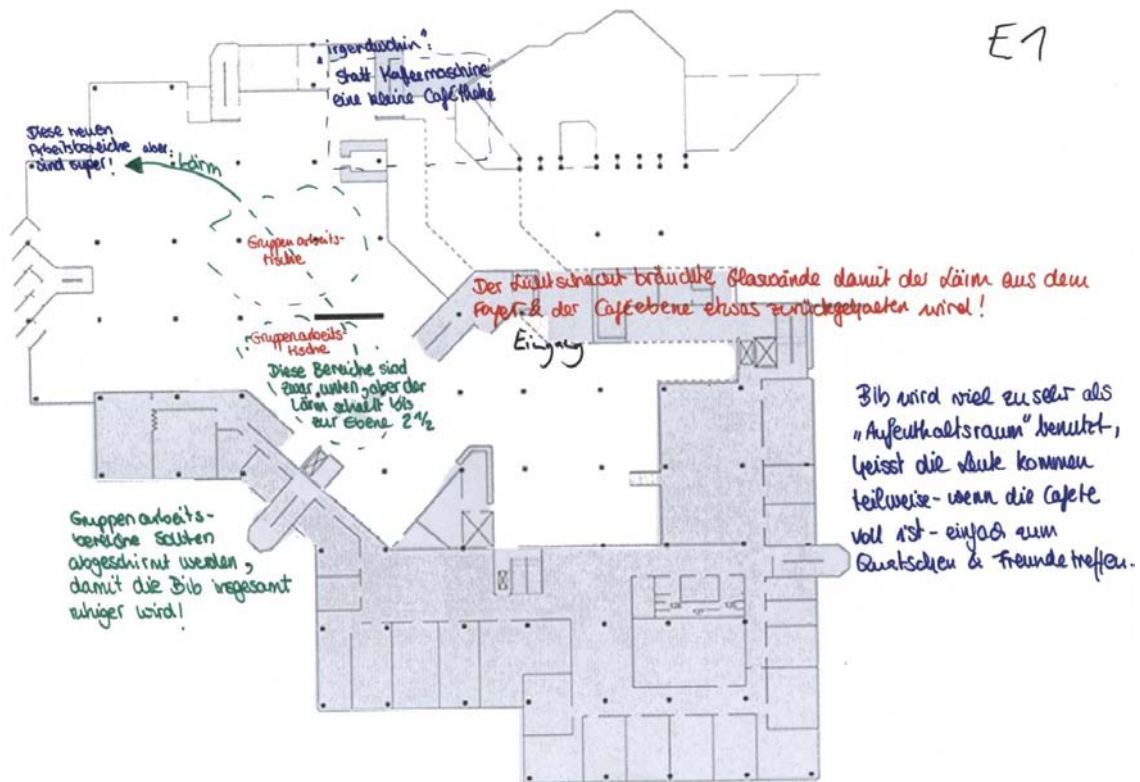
Grundrissplan der Ebene 1 (Petra)
